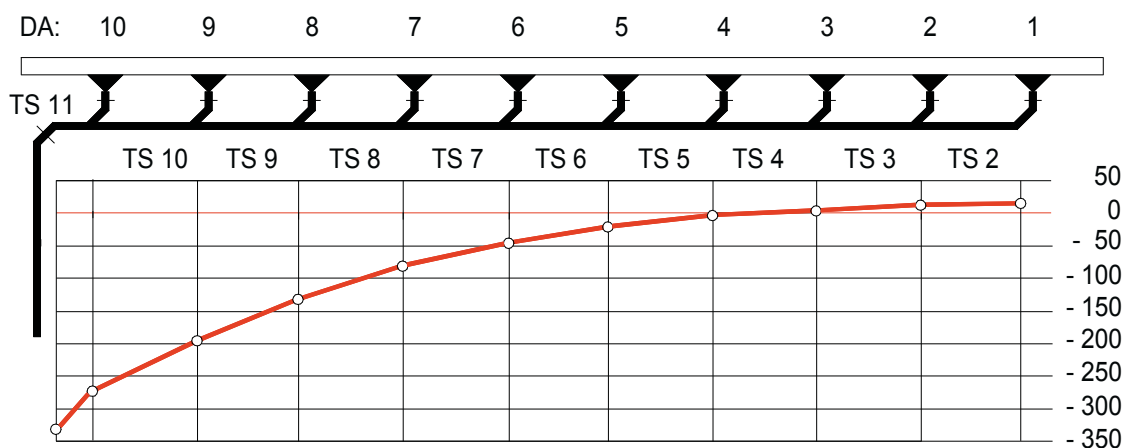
Typischer Verlauf des statischen Drucks in der Sammelanschlussleitung einer Druckentwässerungsanlage
